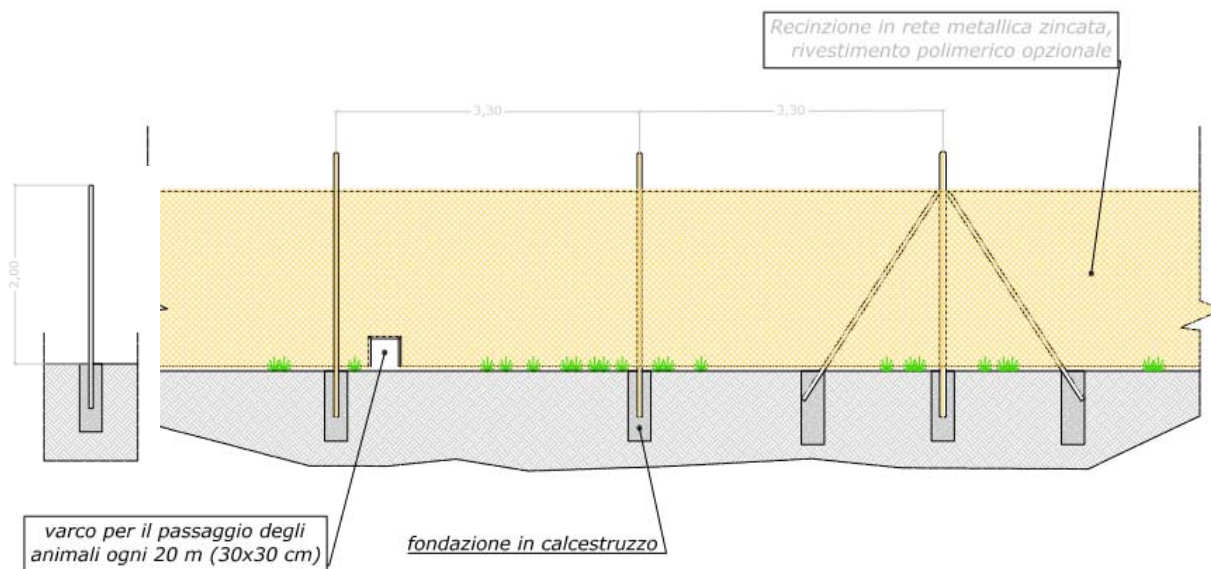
Prospetto e sezione laterale della recinzione perimetrale
